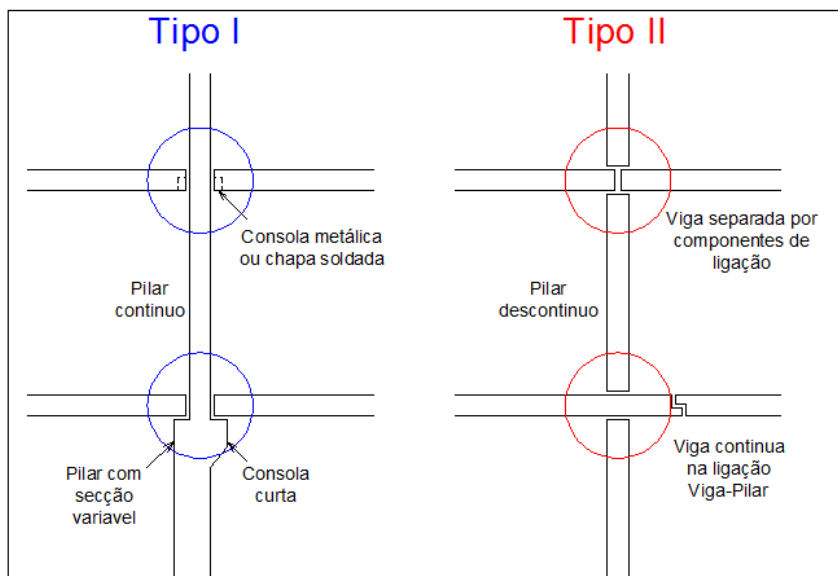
Tipos de ligação entre viga e pilar (Simões de Oliveira, 2012).
